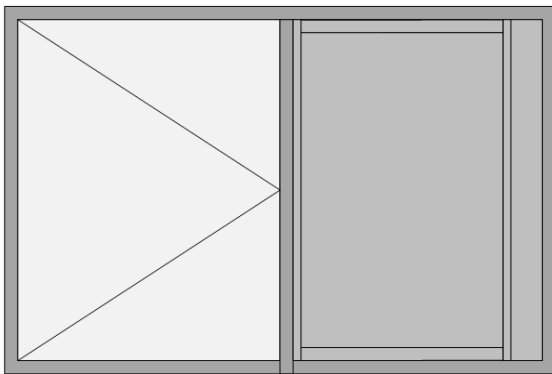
Fenster mit nicht öffnenbarem Blindabschluss
